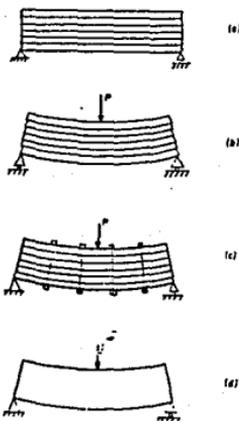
Viga compuesta de placas donde puede observarse el esfuerzo cortante vertical y el esfuerzo horizontal.
